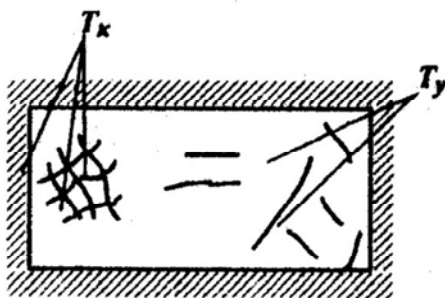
Трещины на потолочной поверхности плиты перекрытия, образовавшиеся от усадки бетона и коррозии арматуры:
